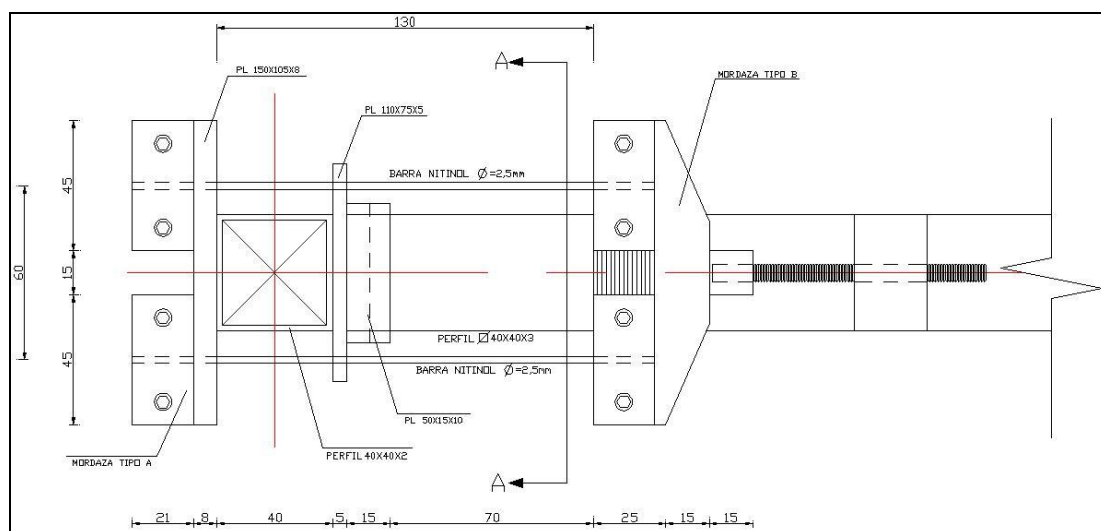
Detalle de la Conexión SMA. Vista en Planta.
